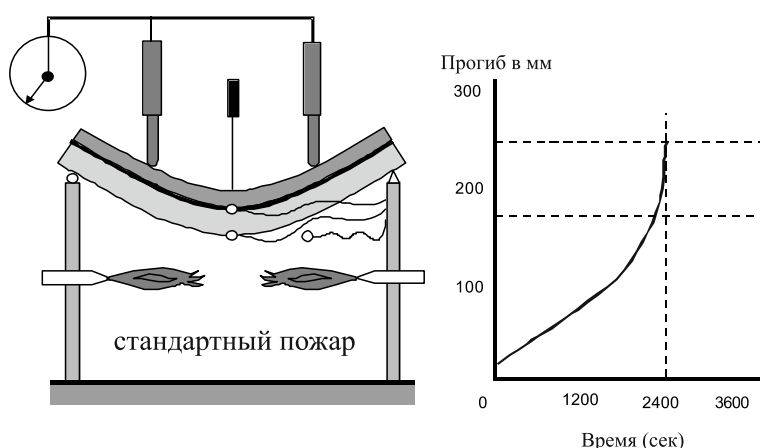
Схема испытаний сталежелезобетонного элемента на изгиб при действии пожарной нагрузки в соответствии с [10]
